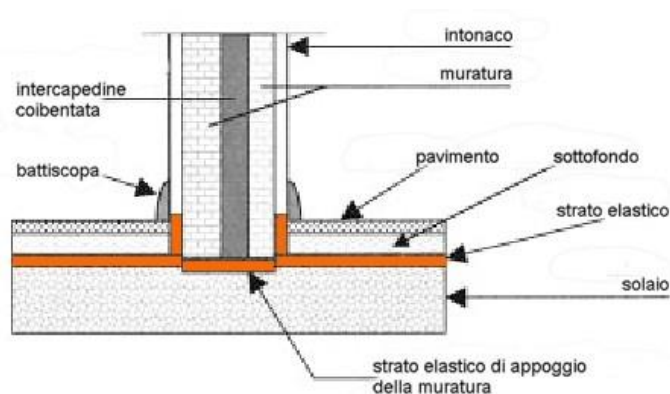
Sezione verticale: corretta realizzazione di giunto solaio-parete desolidarizzato
